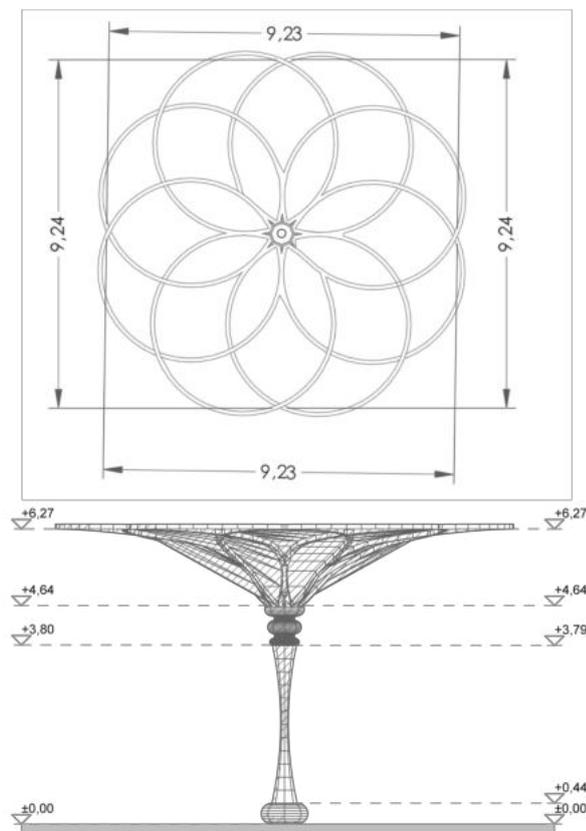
Planos 6 – Vista frontal y planta arquitectónica de pérgola. Fuente: Elaboración propia Nota: Visualización de pérgola árbol
